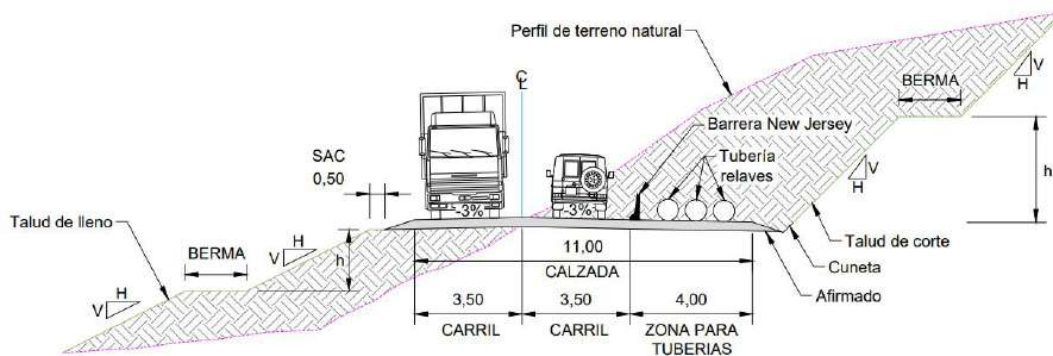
Sección típica vía para operación – Ancho de 11,0 m
